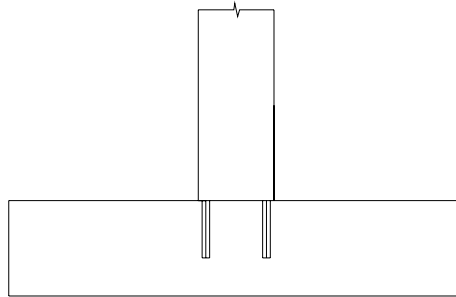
Ligação pilar-fundação com armadura saliente do pilar [11]
